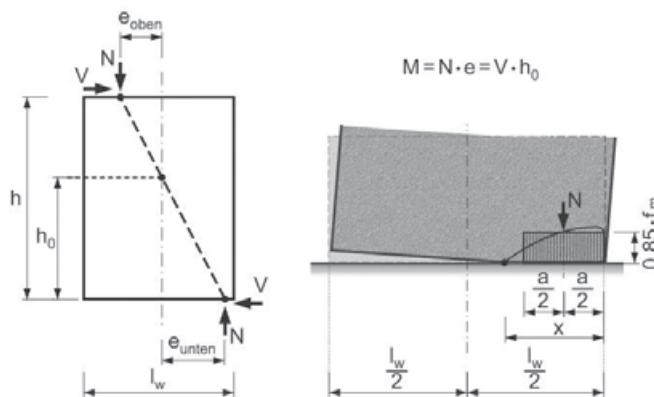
Kräftegleichgewicht an einer Wandscheibe
